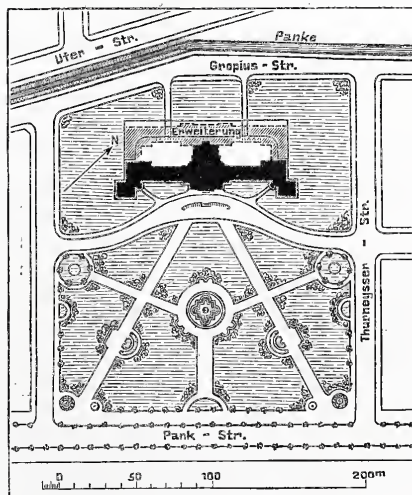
Lageplan. Amtsgericht Berlin-Wedding.
